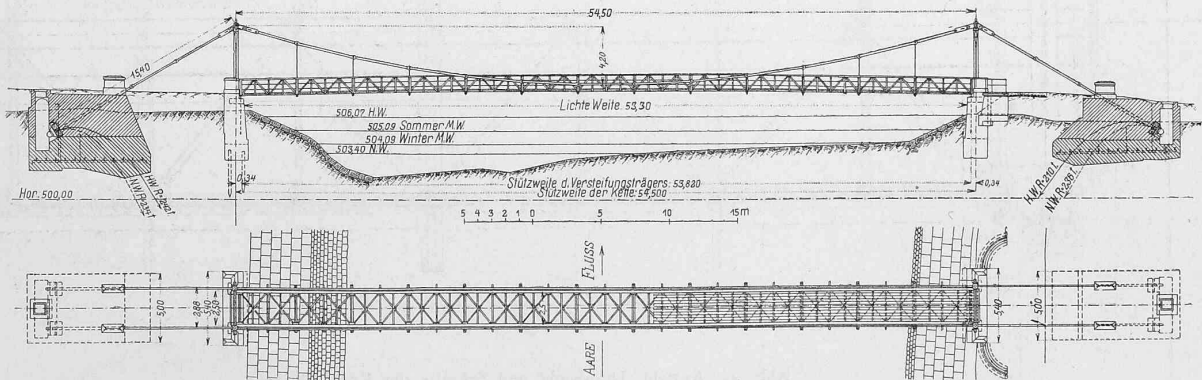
Uebersichtsplan des Kettensteges. Ansicht und Grundriss. — Masstab 1 : 500.
